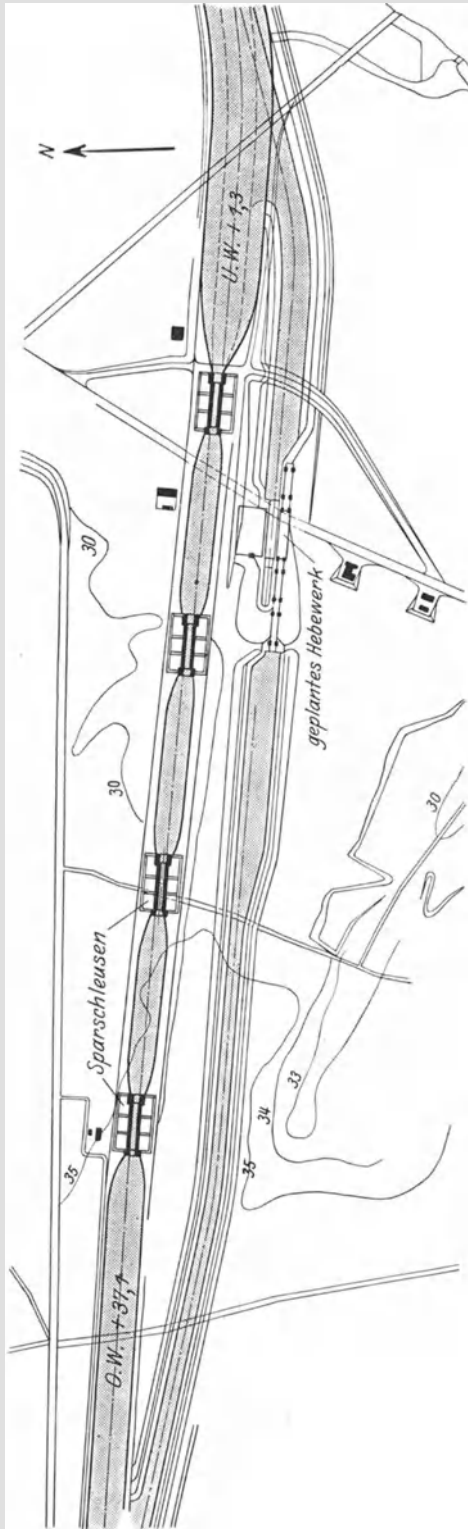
Schleusentreppentreppe Niederfinow mit Sparschleusen.
